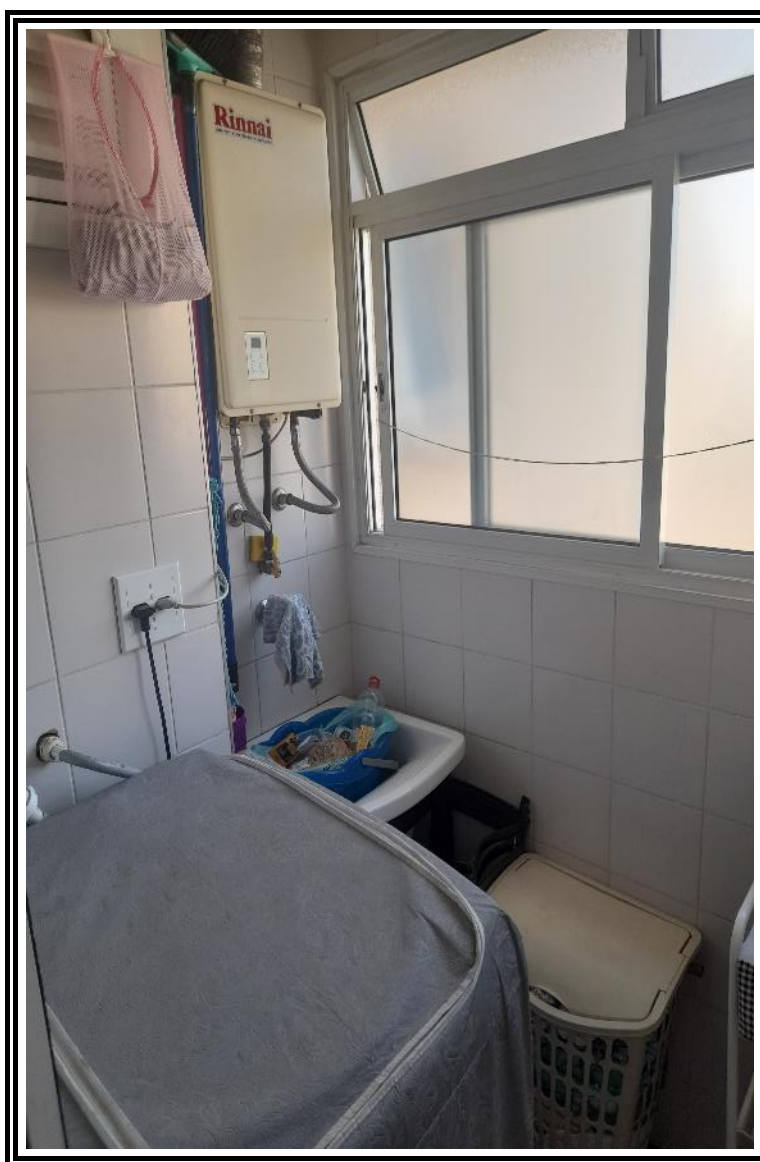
Vista da área de serviço (imóvel similar vistoriado)
